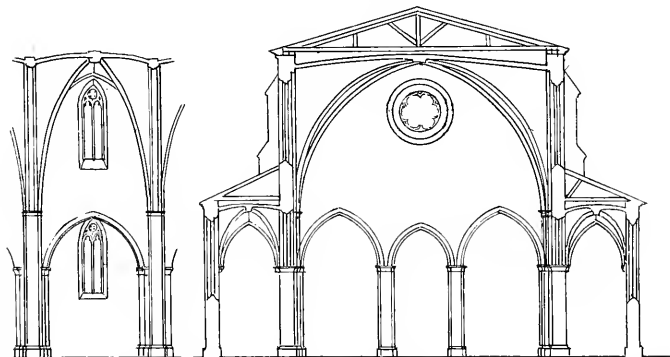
N.-D. du Taur; élévation d'une travée et coupe sur AB.
